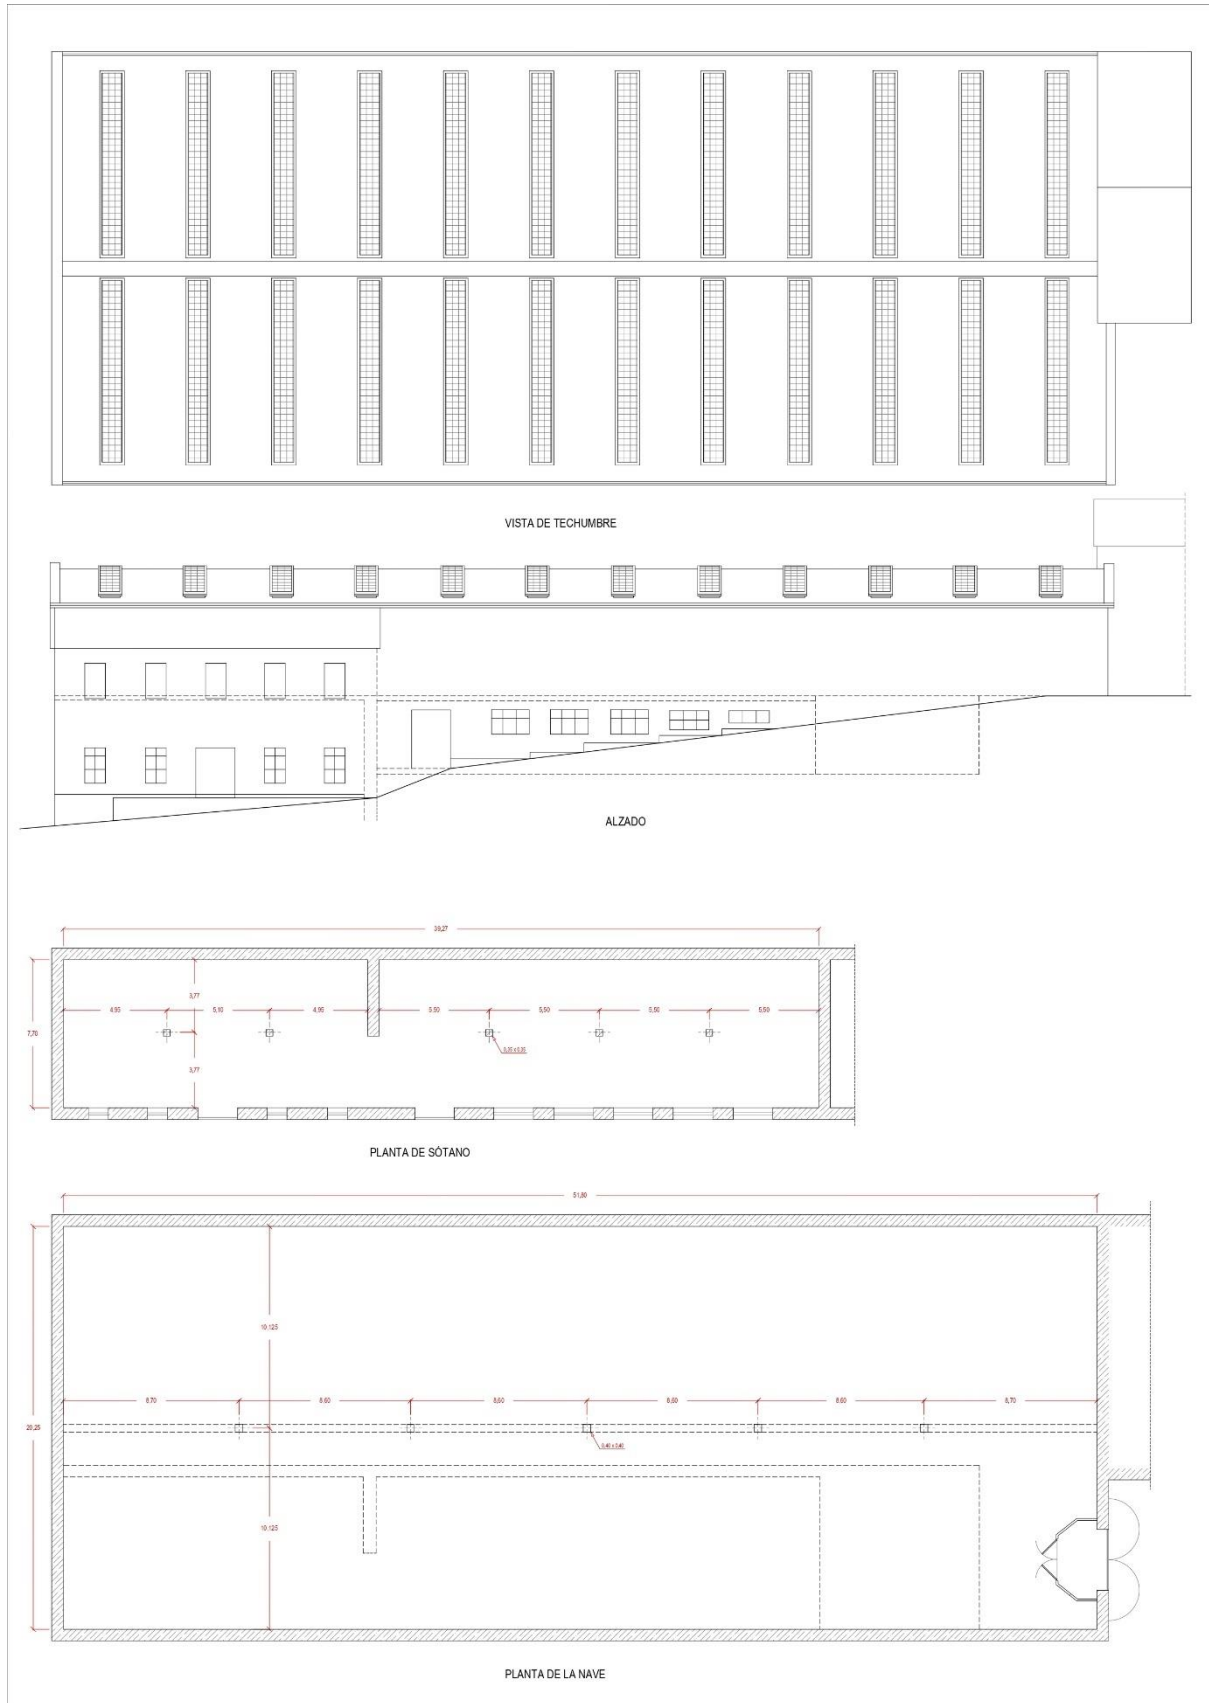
Industrial – Hilaturas. Planta de cubiertas, baja y sótano (E 1:100) y alzado lateral (1:100)
